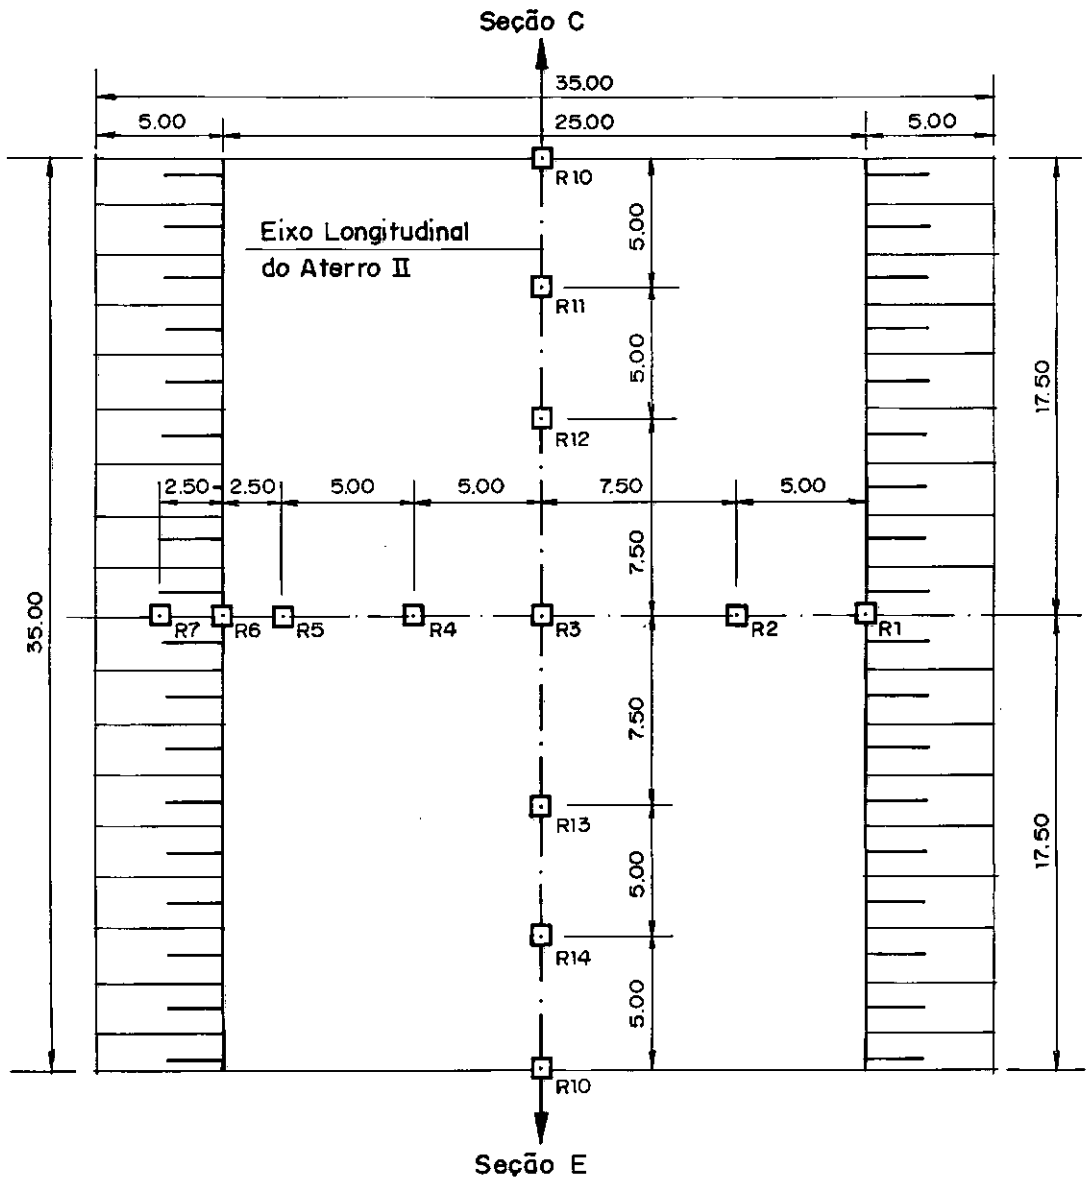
Localização das placas de recalque em planta - Seção D.
